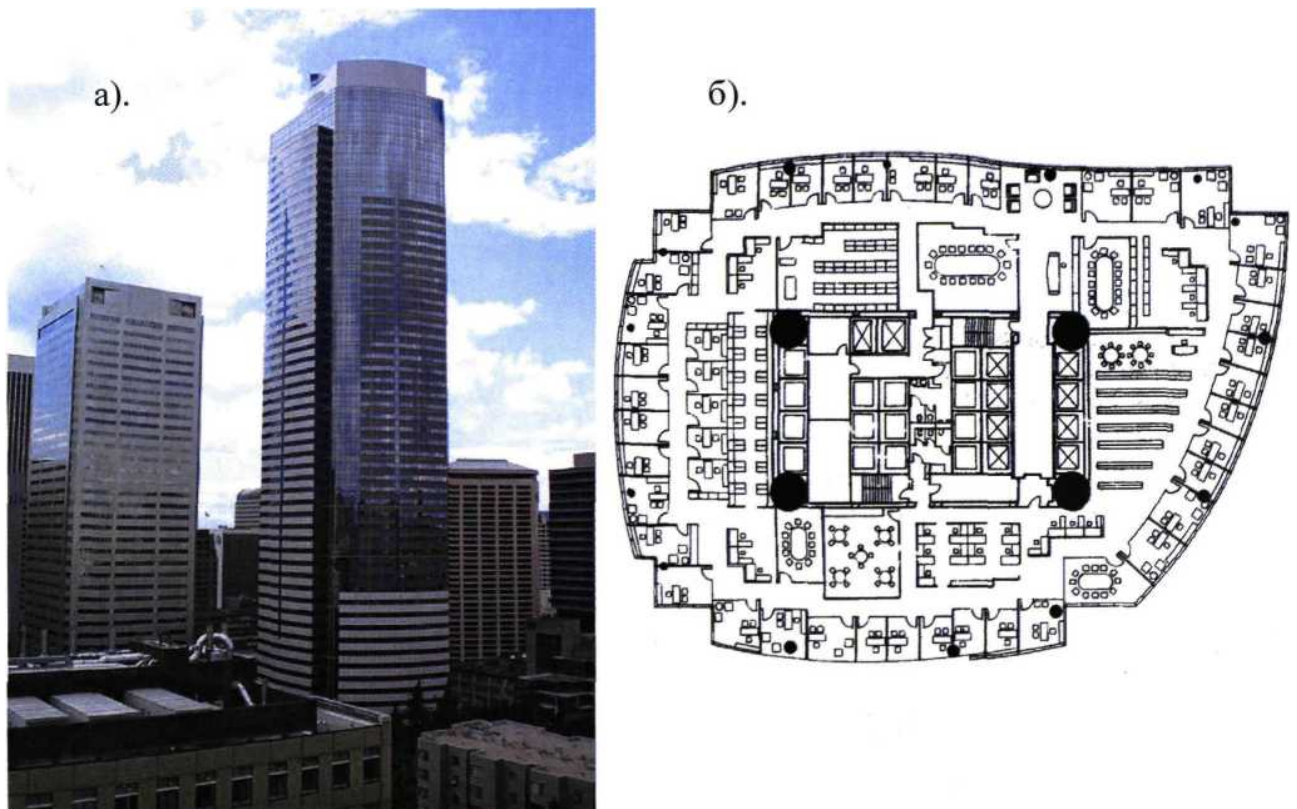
58-ми поверхова будівля «Two Union Square» з несучими конструкціями з трубобетонних: а - загальний вигляд будівлі; б - план типового поверху
